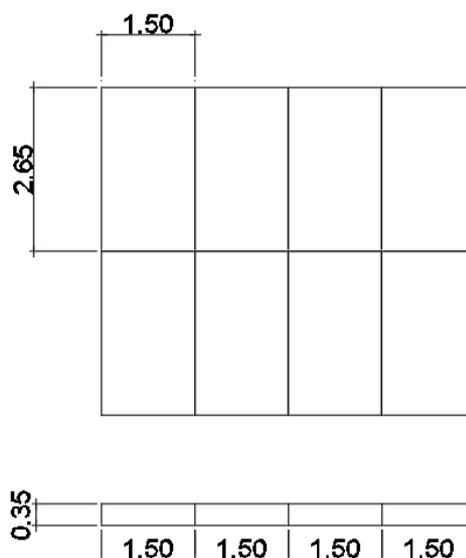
Geometría de las losas superiores. Fuente: Elaboración propia.
